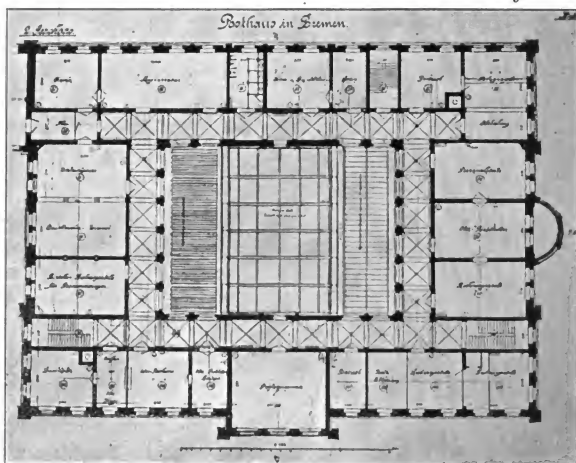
Hauptpostgebäude. Grundriß des Hauptgeschosses.
